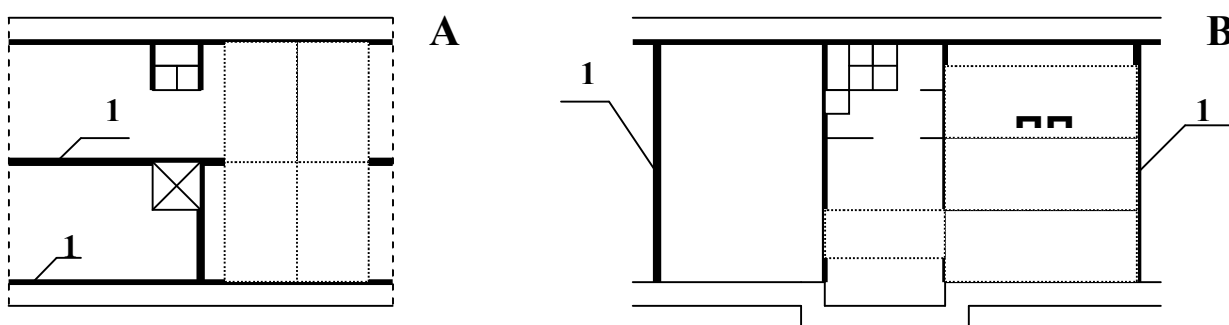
Конструктивные схемы крупнопанельных зданий: А – с продольными несущими стенами; В – с поперечными несущими стенами. 1 – несущие стены, ПП – панели перекрытий.
